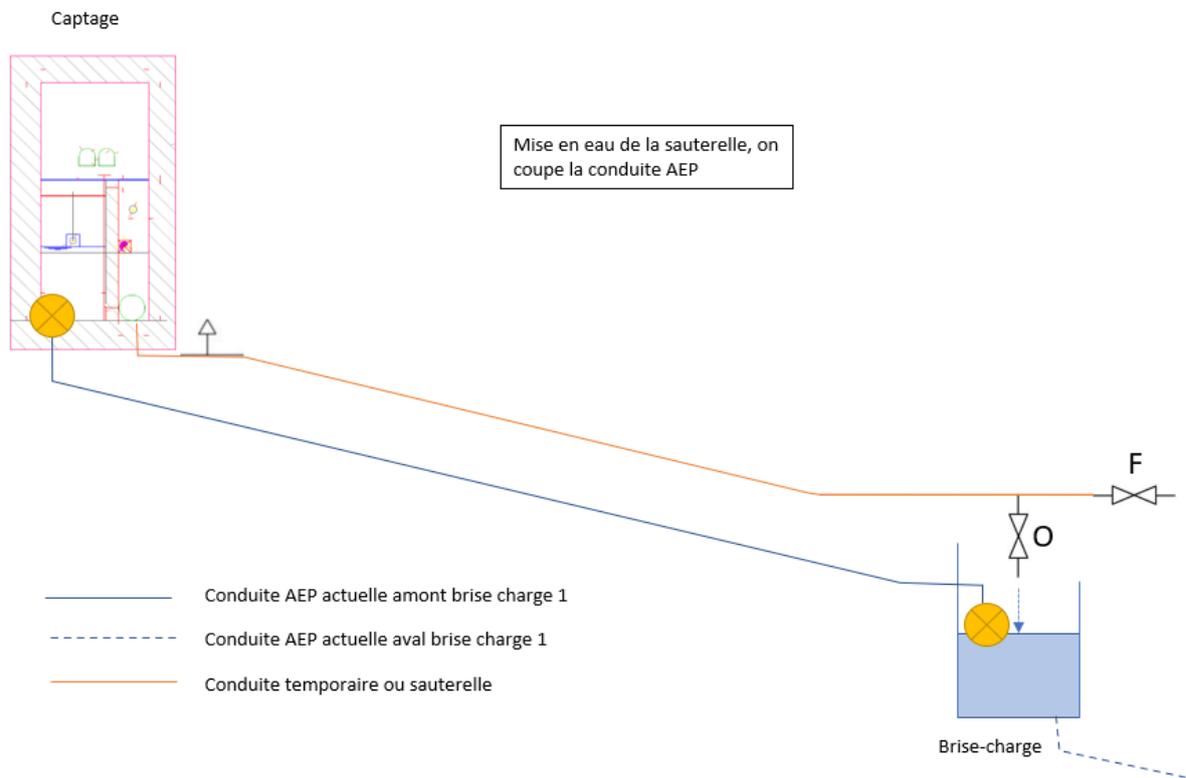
Alimentation par la conduite temporaire et isolement de la conduite actuelle
